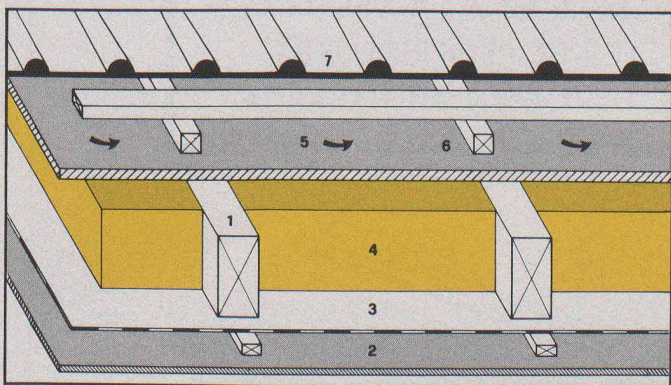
Montage d'une sous-toiture (ISOROOF)
